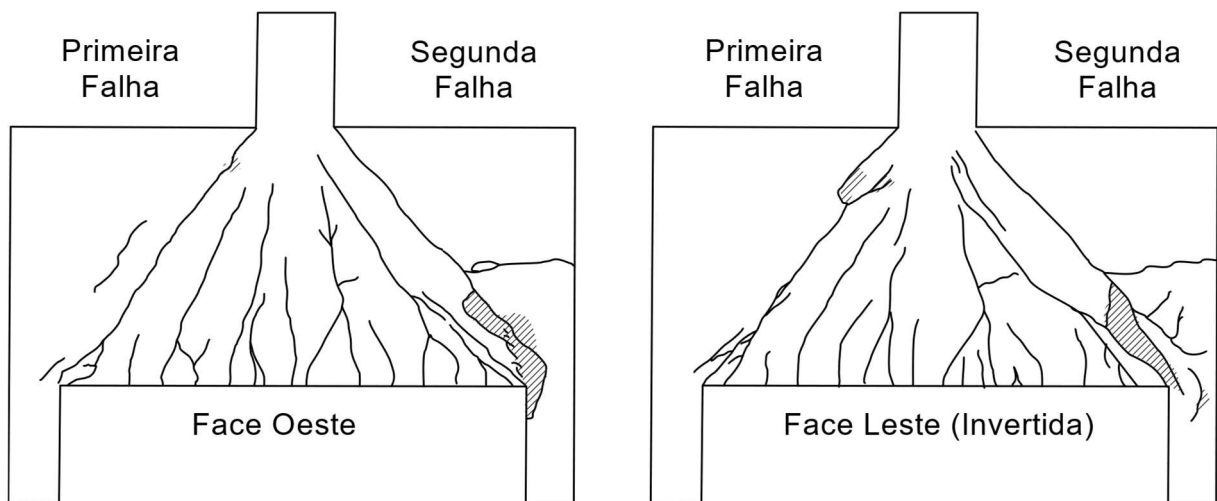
VIGA 1/10 POR ROGOWSKY et al. (1983)
